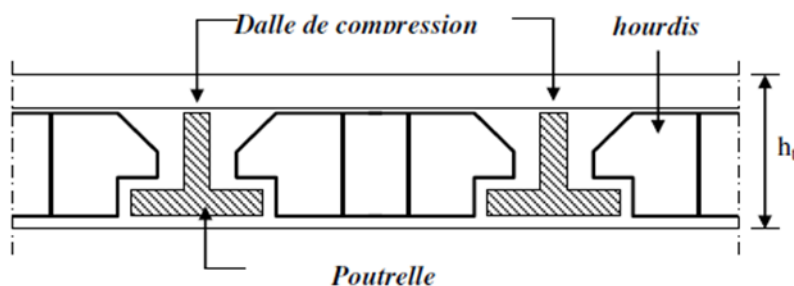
COUPE D'UN PLANCHER A CORPS CREUX
